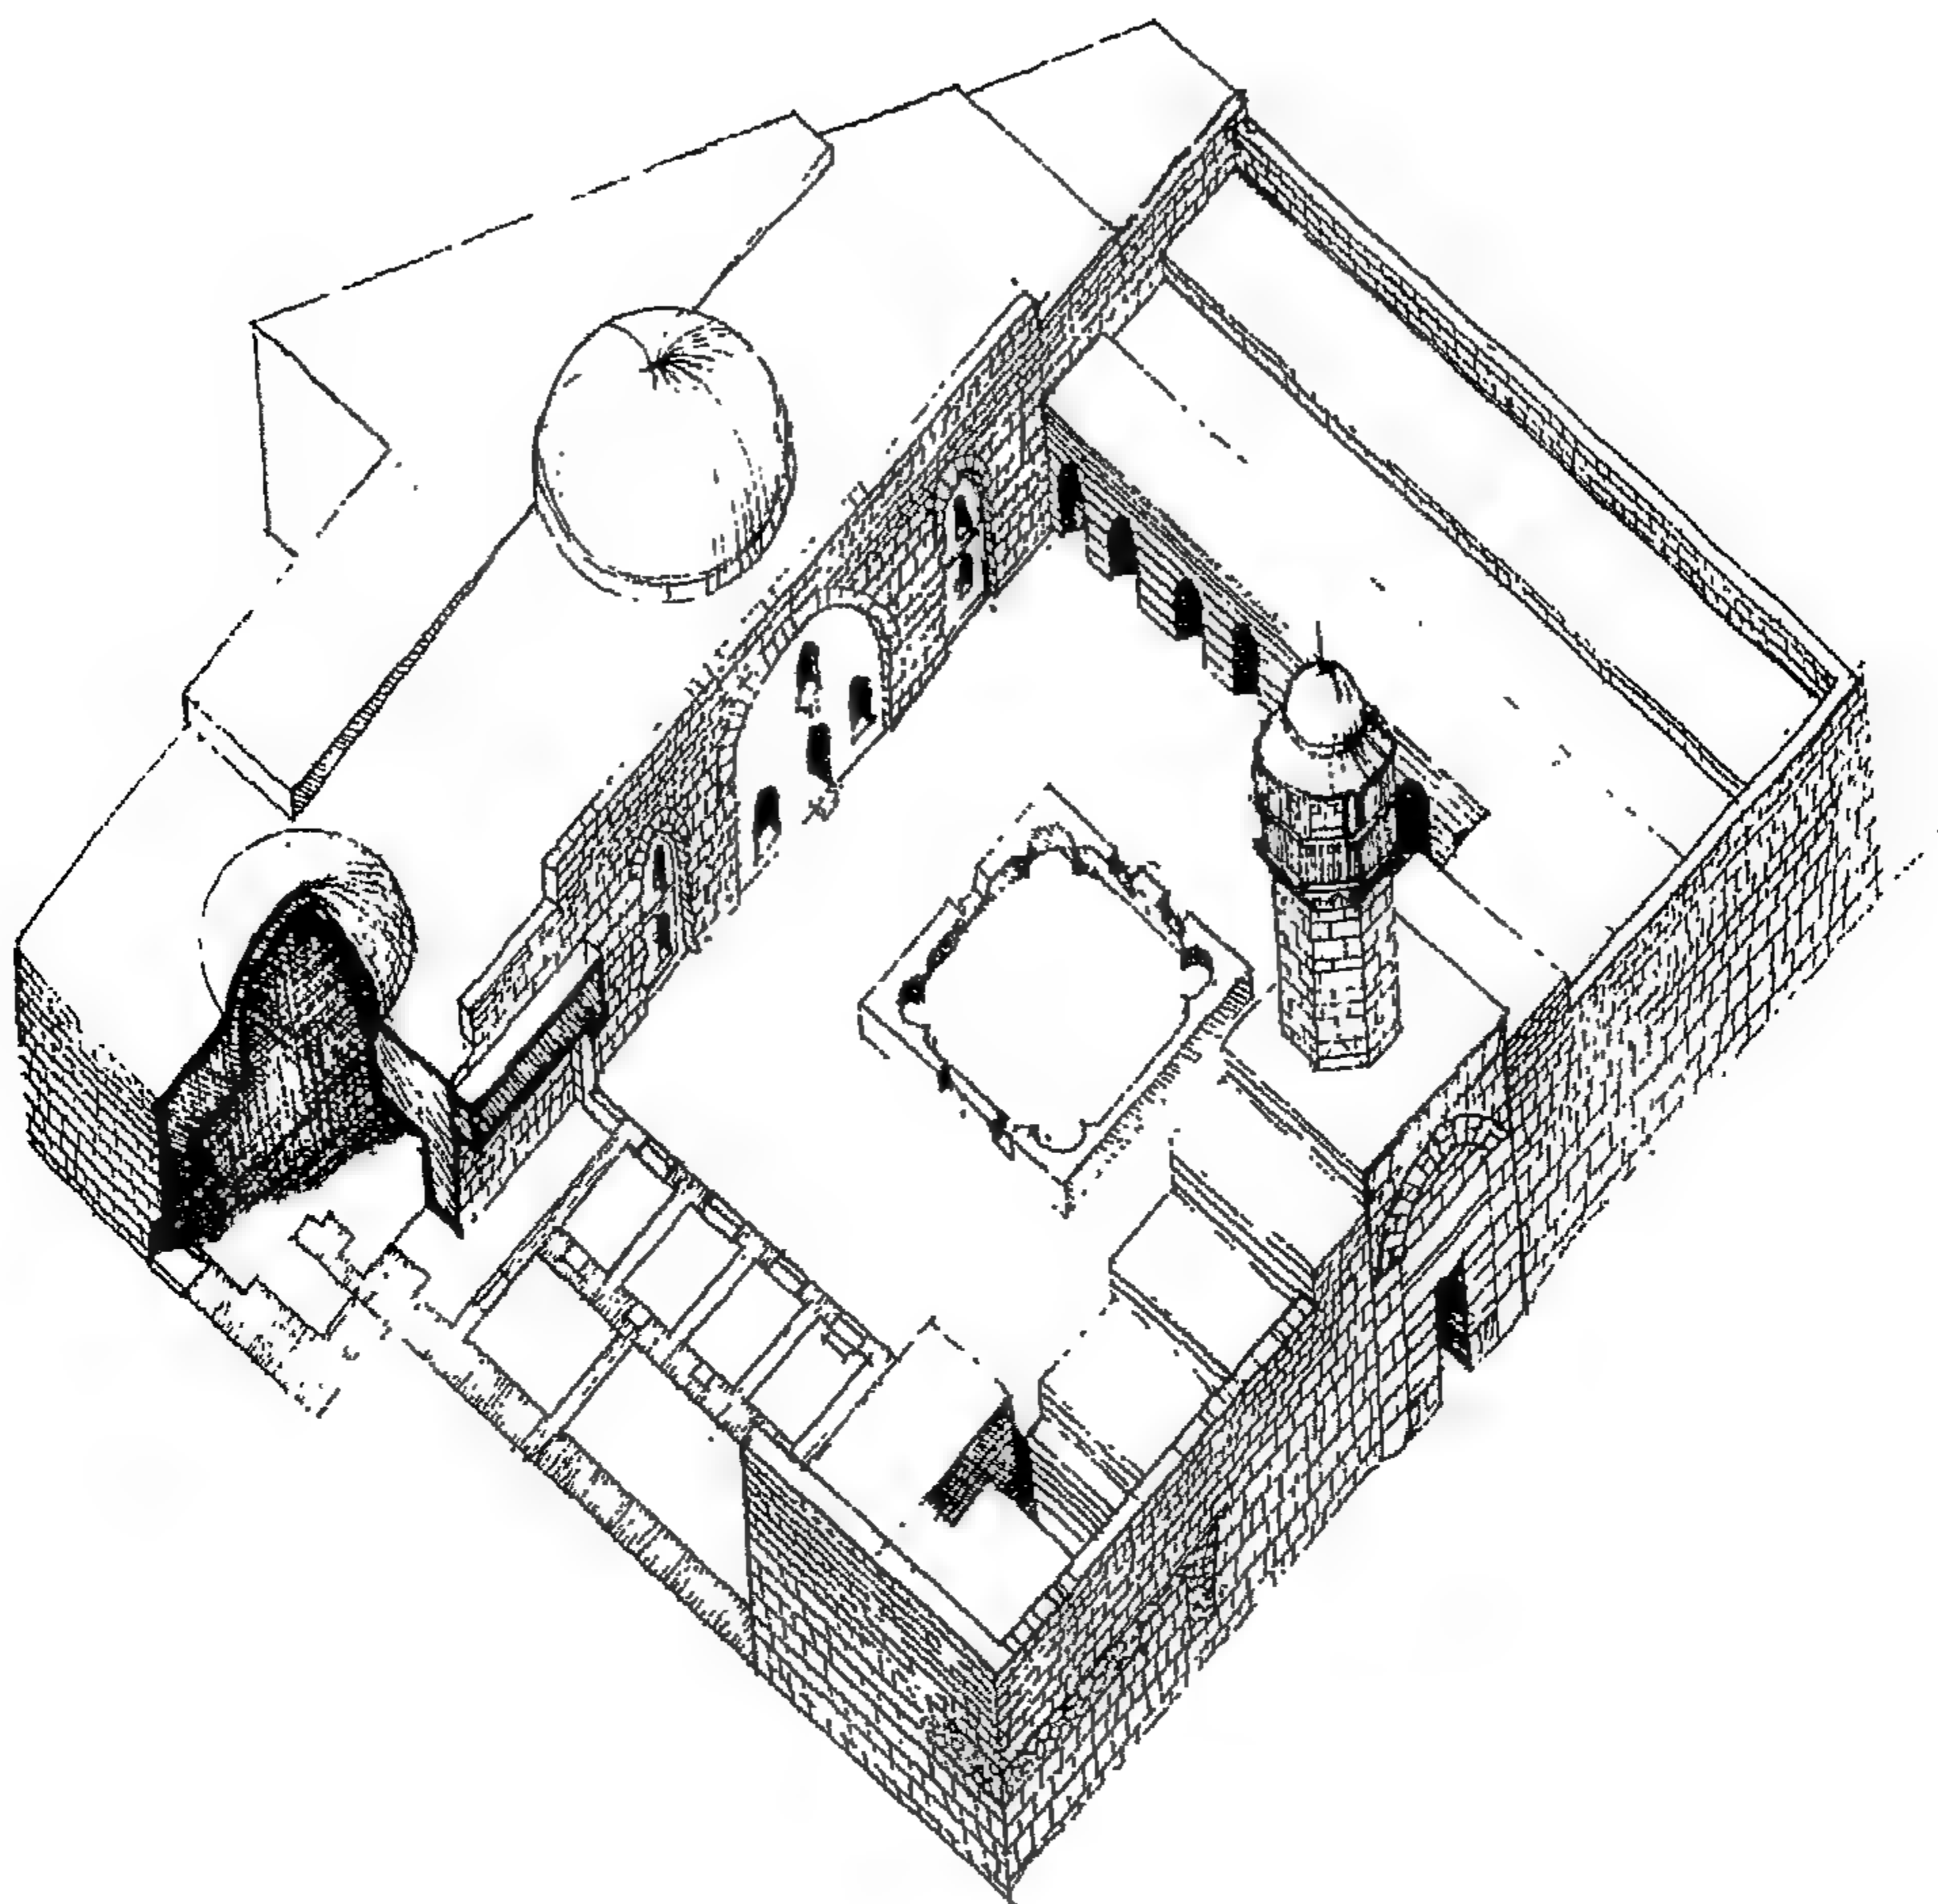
مسقط أفقي لمدرسة شاذيخت في حلب ٥٨٩هـ/١١٩٣م (عن: كريزول).
